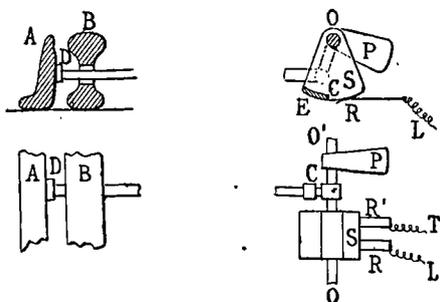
et 553. — Contrôleur d'aiguille; coupe et plan.
